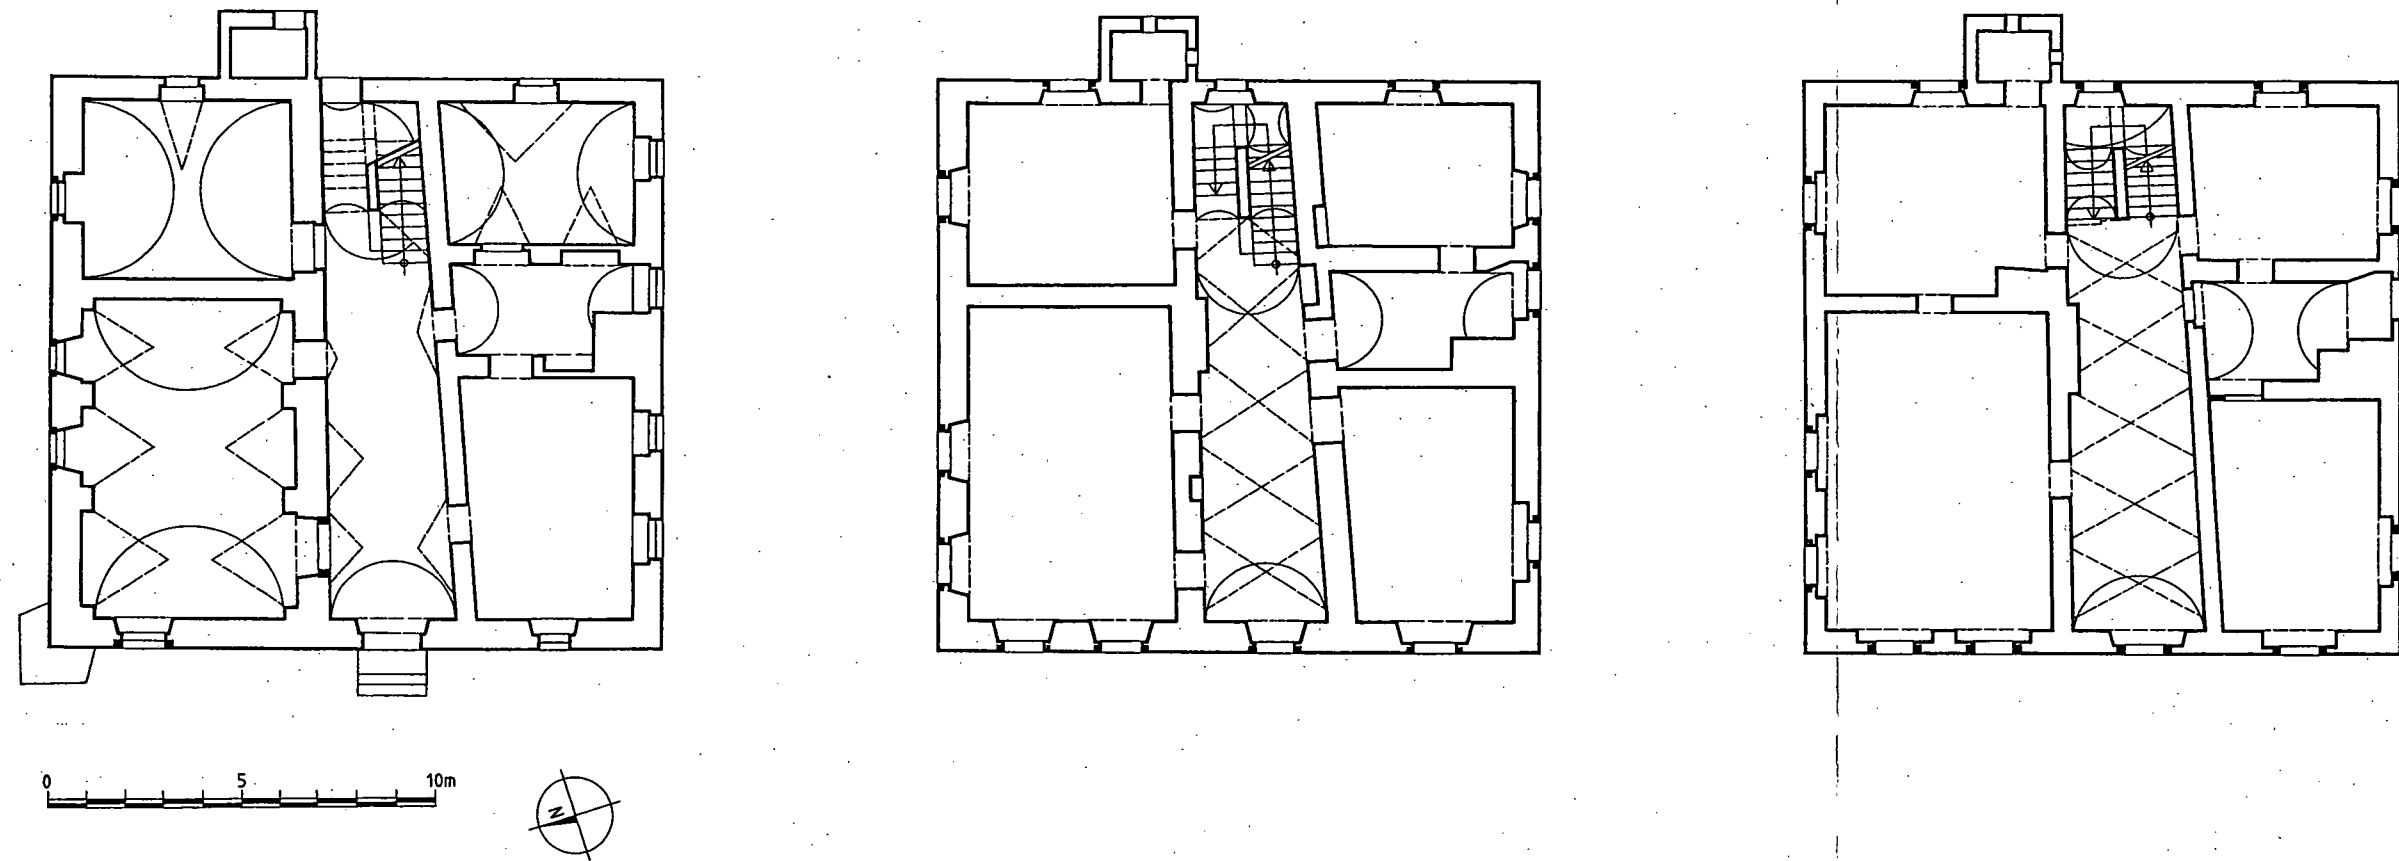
Schiferplatz 7 – Grundrisse Erdgeschoss, 1. und 2. Obergeschoss (1:200).
